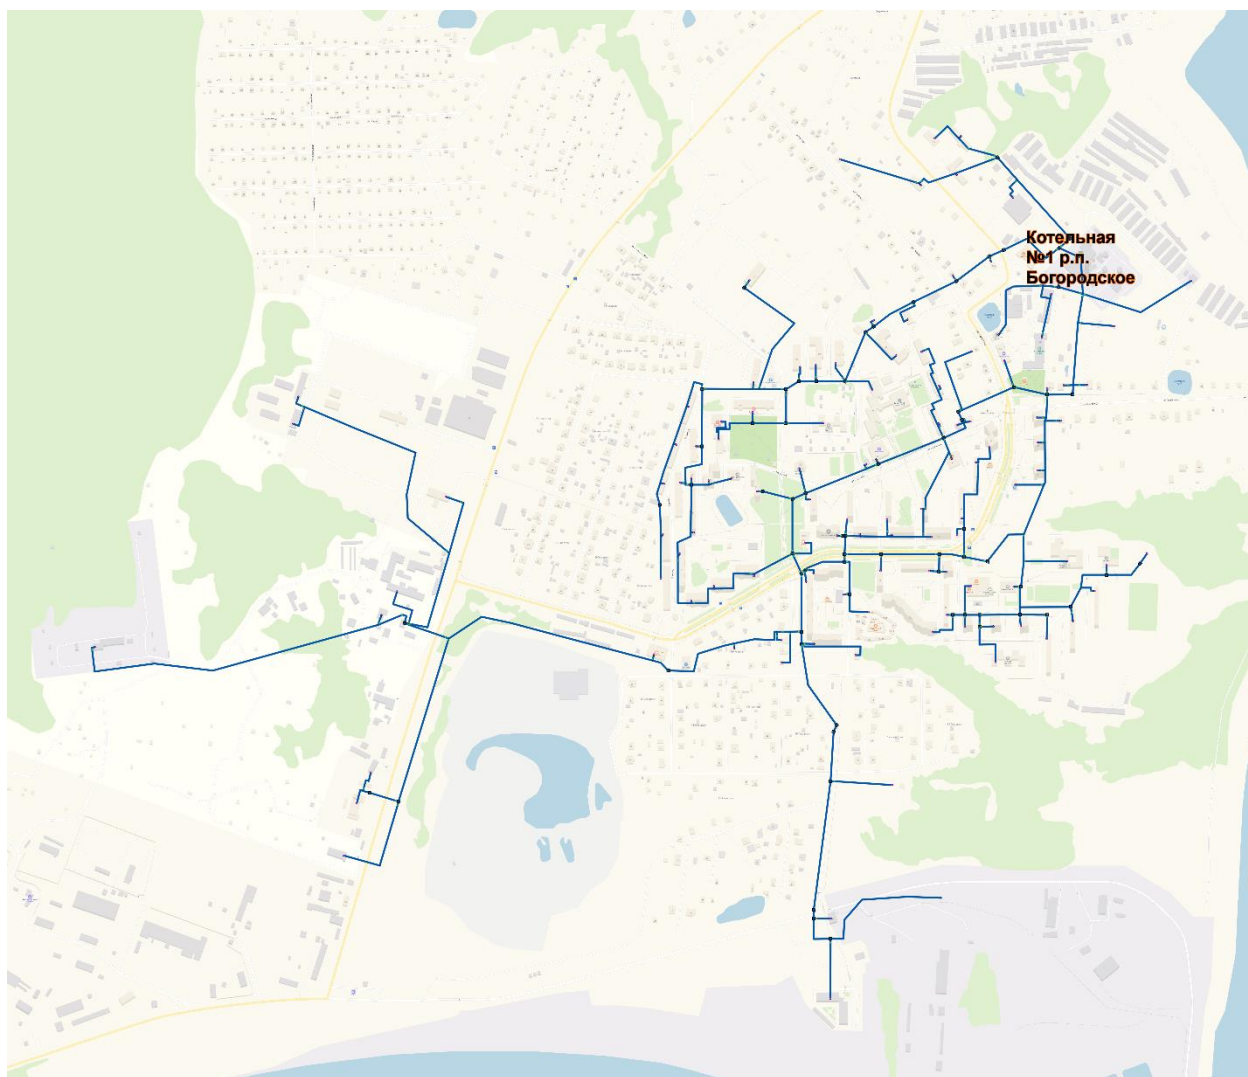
Схемы тепловых сетей от Котельная №1 р.п. Богородское
